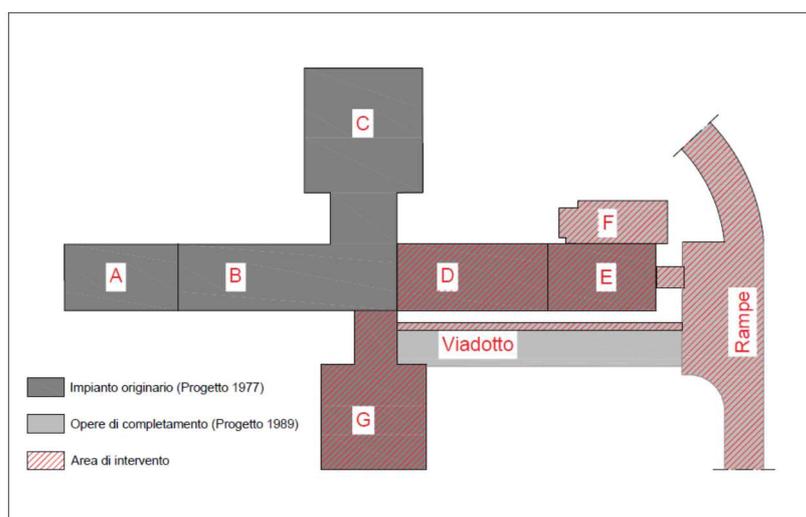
Le fabbriche ed i collegamenti interessati dall'intervento
